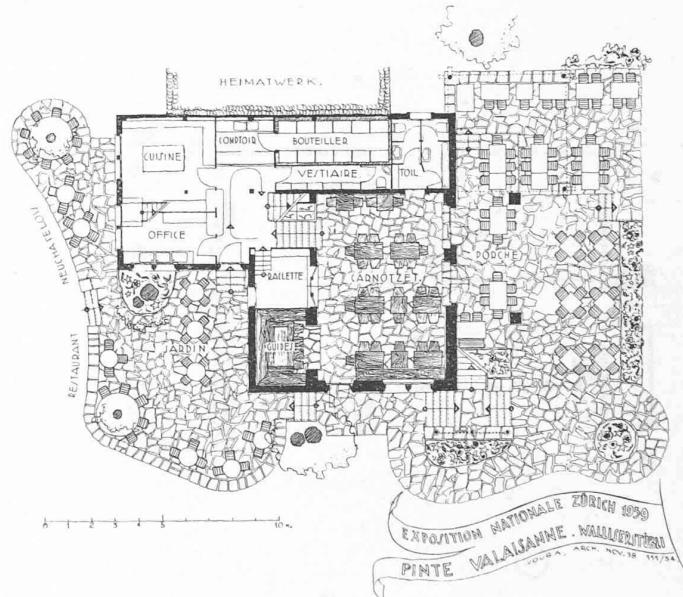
La « Pinte valaisanne ». Plan du rez-de-chaussée.
